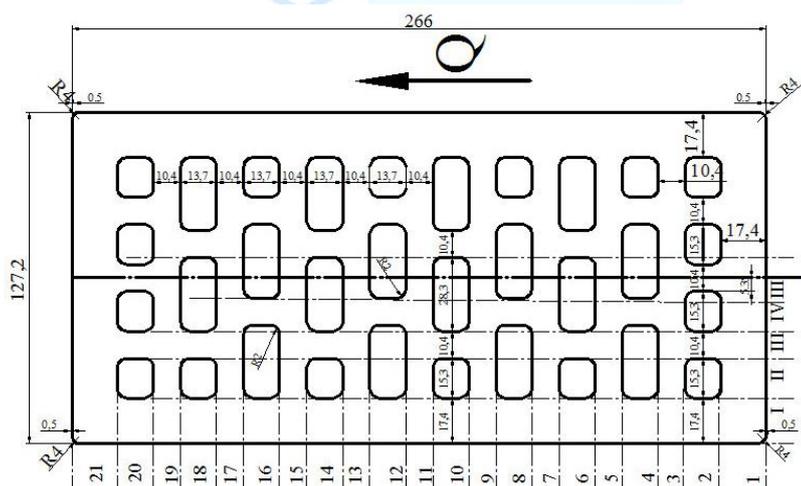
Расчетная схема мелкого блока из пенобетонного камня с 48 сквозными щелевидными пустотами
